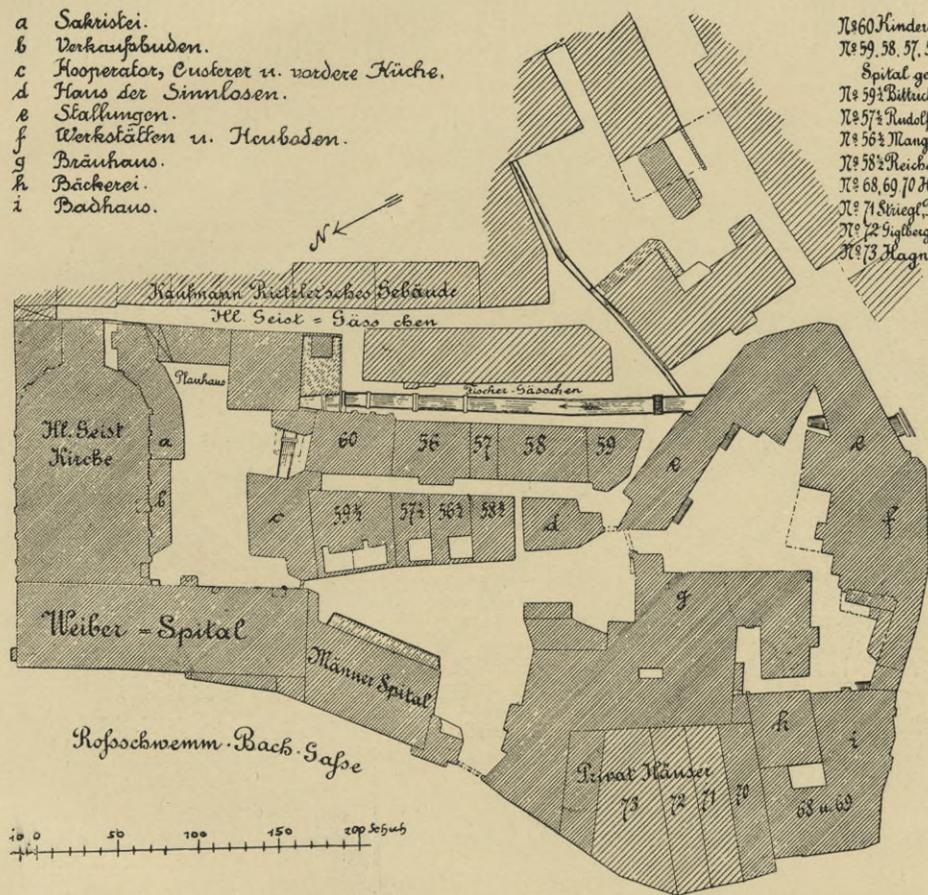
Lageplan des Heiliggeistspitals um 1600.
